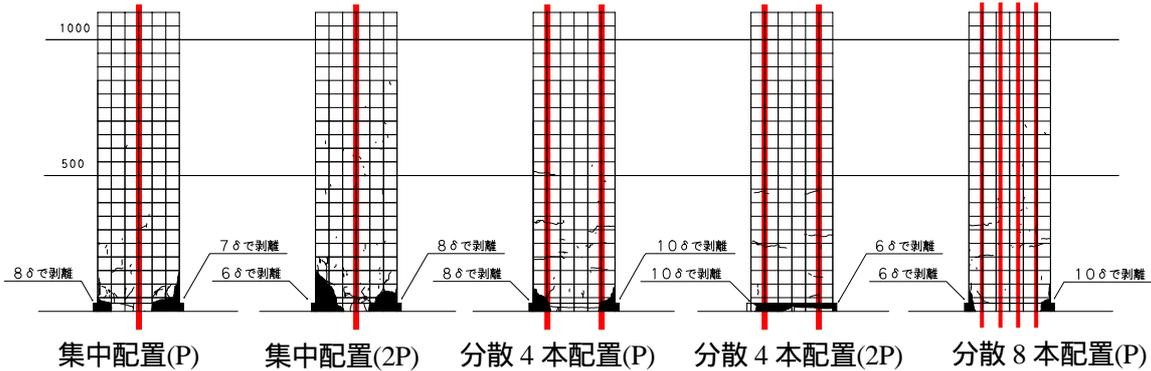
載荷終了時の損傷およびひび割れ状況
